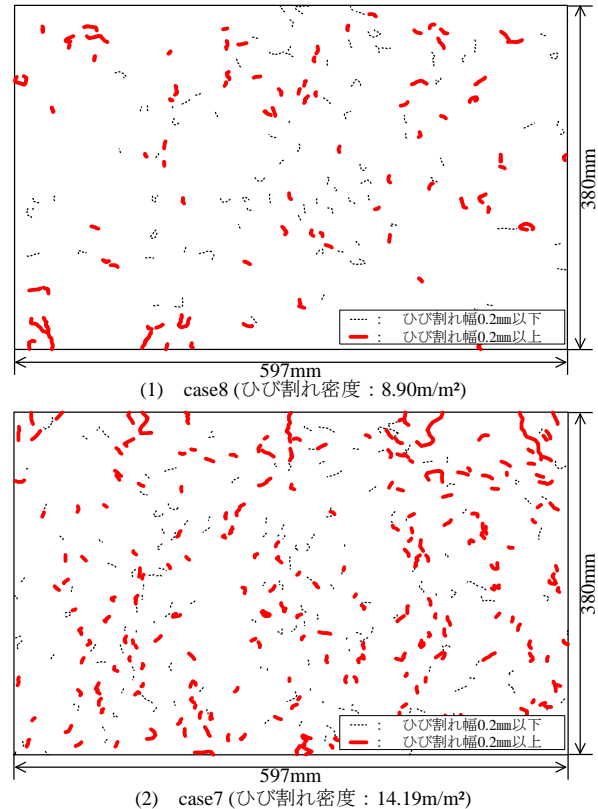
内部ひび割れ状況 (コア側面の展開図)
